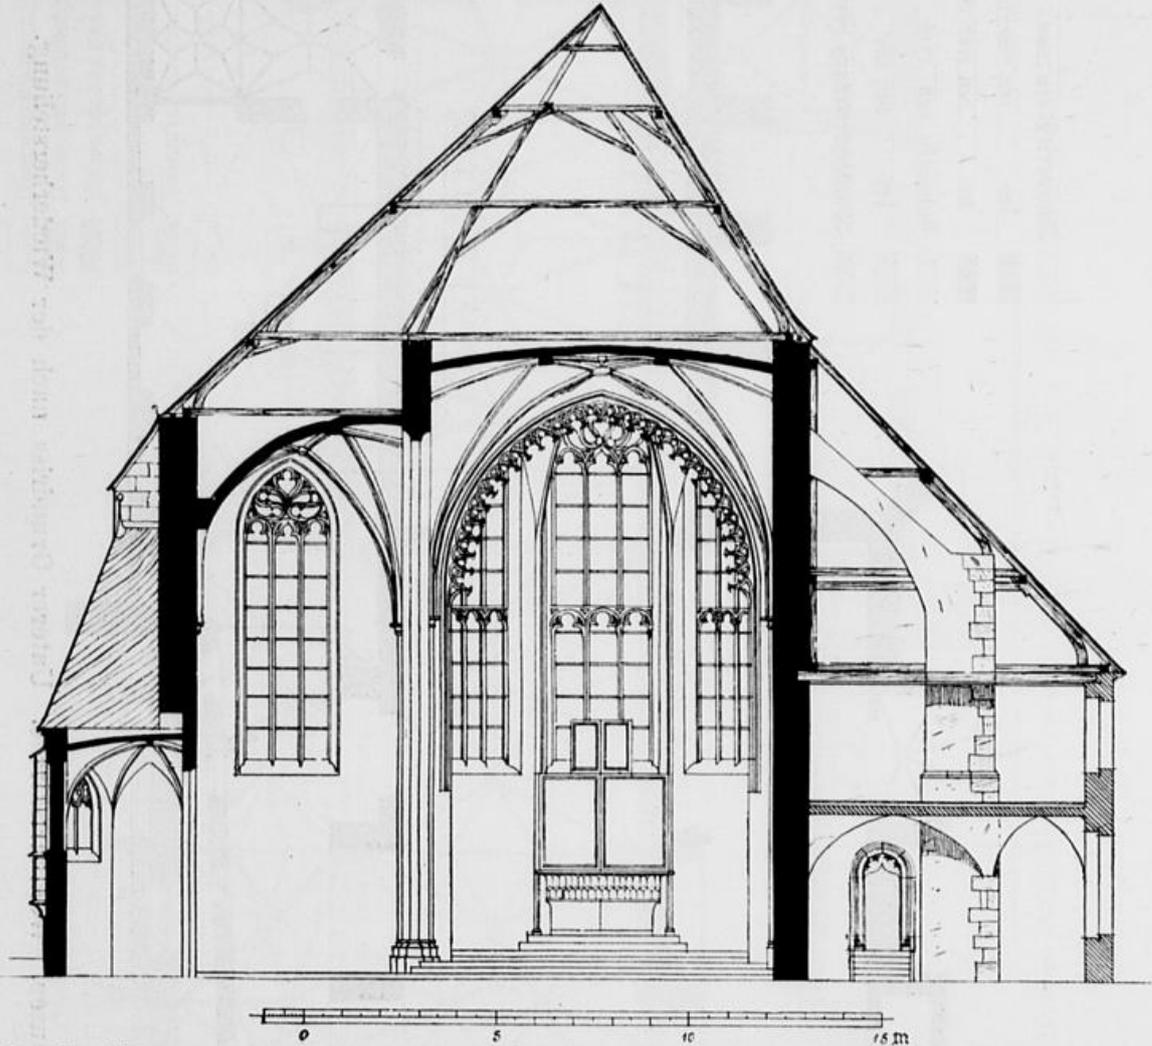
Clausen. Wallfahrtskirche. Schnitt mit wiederhergestelltem Strebesystem.
